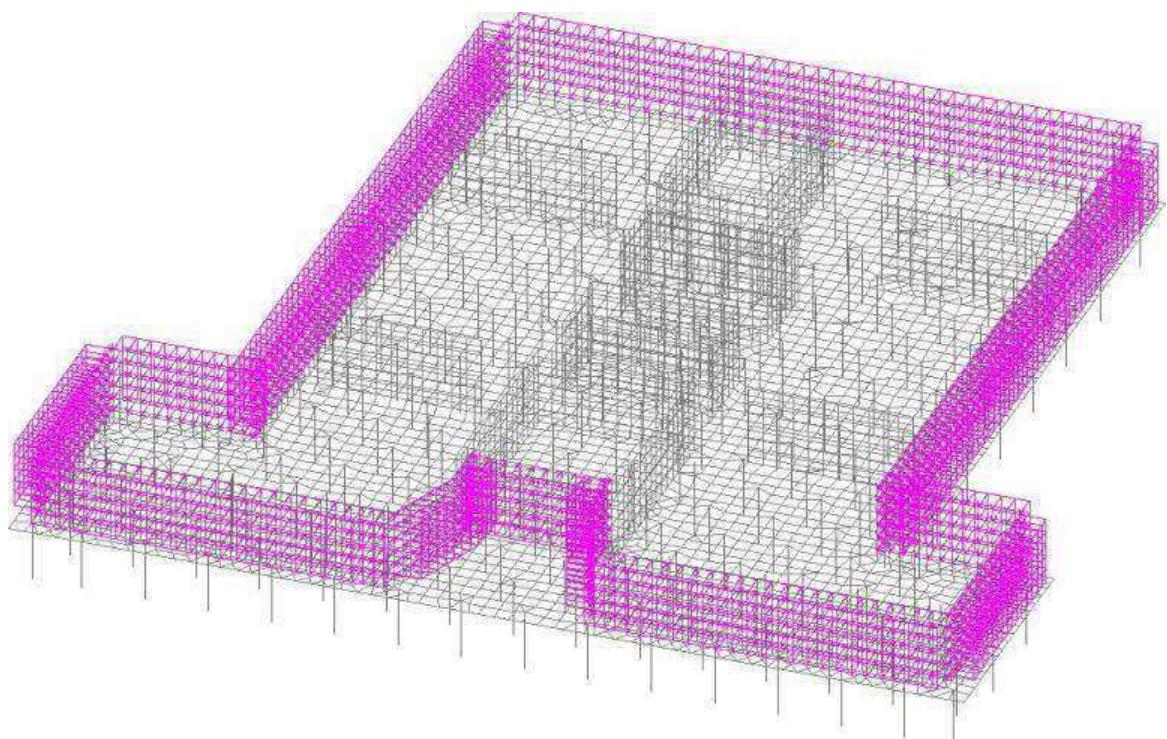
Схема нагрузки грунта на стены цокольных этажей
